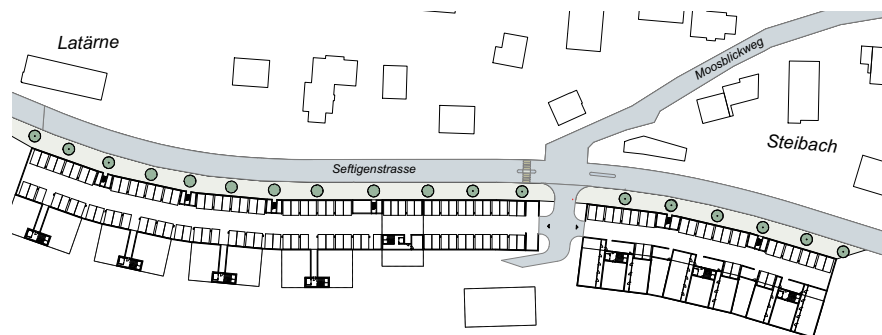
Die Einstellhalle wird beidseitig ab der bestehenden Arealzufahrt erschlossen und erlaubt einen direkten Zugang zu allen Gebäuden.
